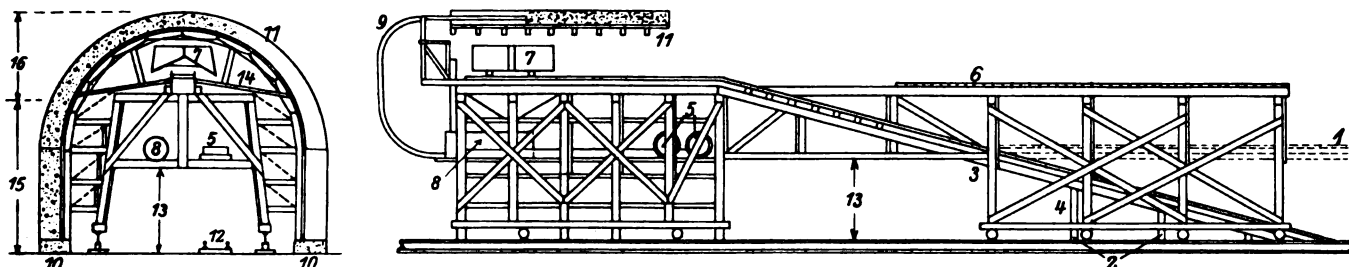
Vorrichtung zum Ausbetonieren der Tunnelwände.
